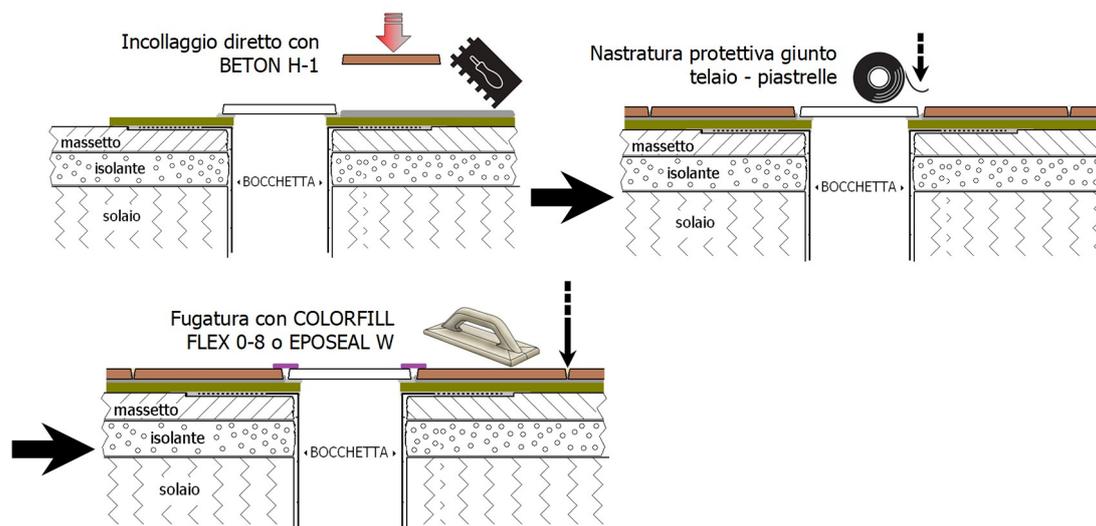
incollaggio diretto e fugatura delle piastrelle
